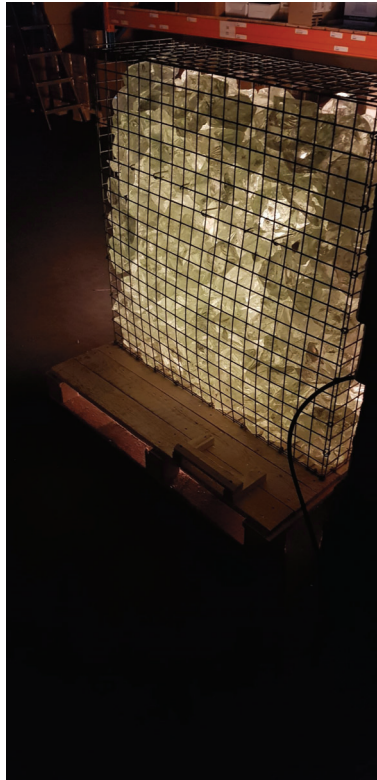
lichtbeeld voorzijde, met een witte plaat aan achterzijde voor meer reflectie
